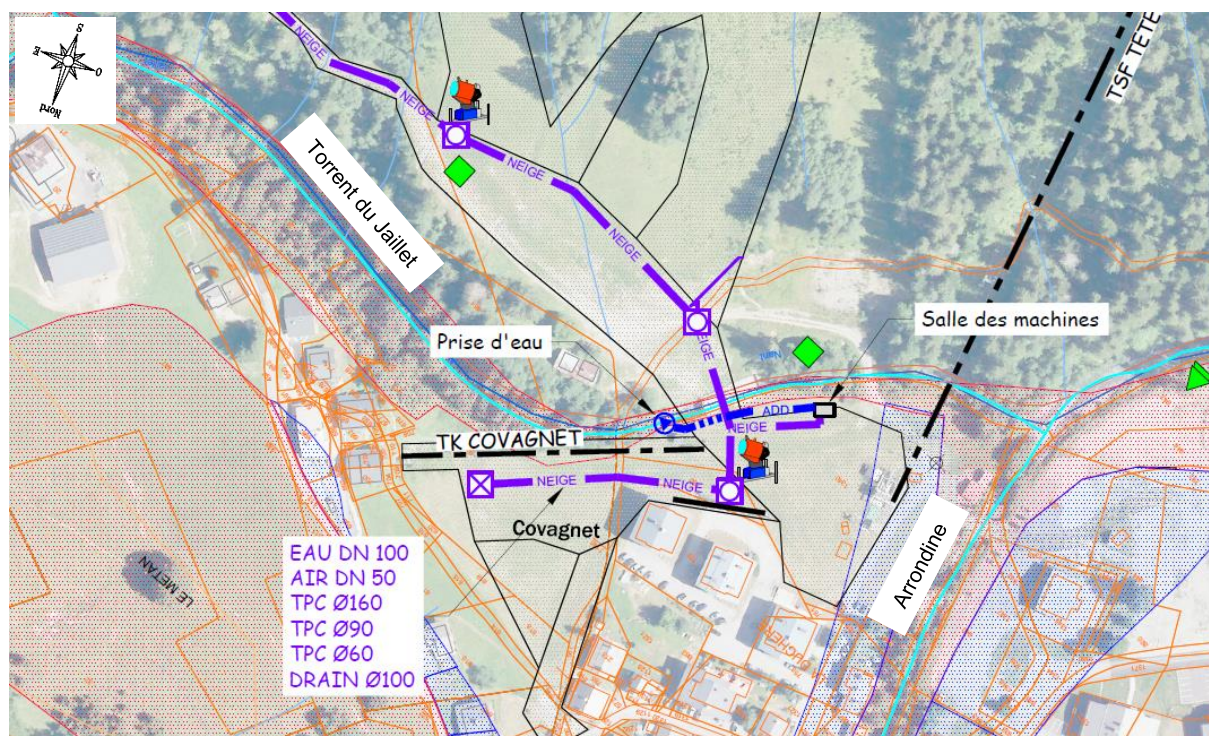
Position de la prise d'eau dans le torrent du Jaillet (extrait du plan général des travaux) – Sans échelle
